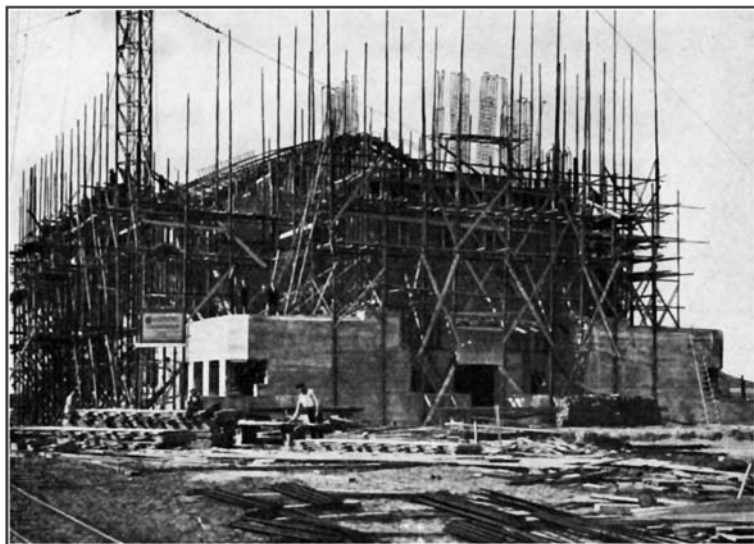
Vorderfront des Sendergebäudes mit den Eisenanlagen für die Betonkuppel Assel)
